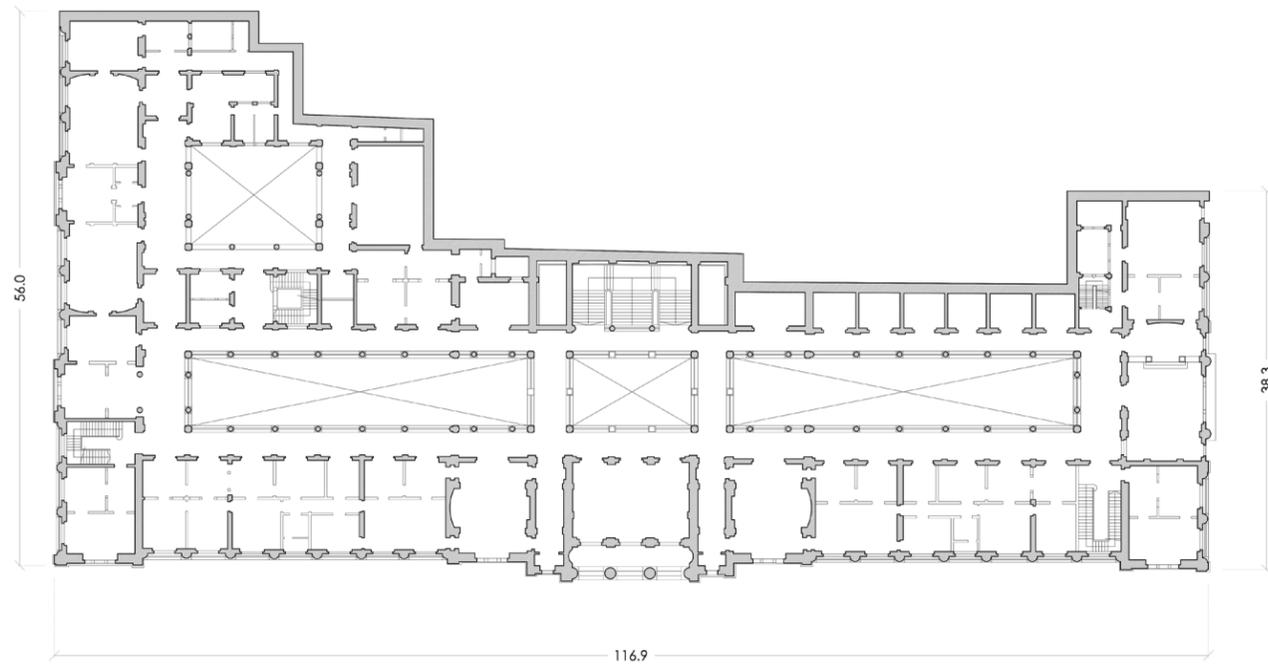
Planimetría hacia 1931 Palacio de Tribunales.
